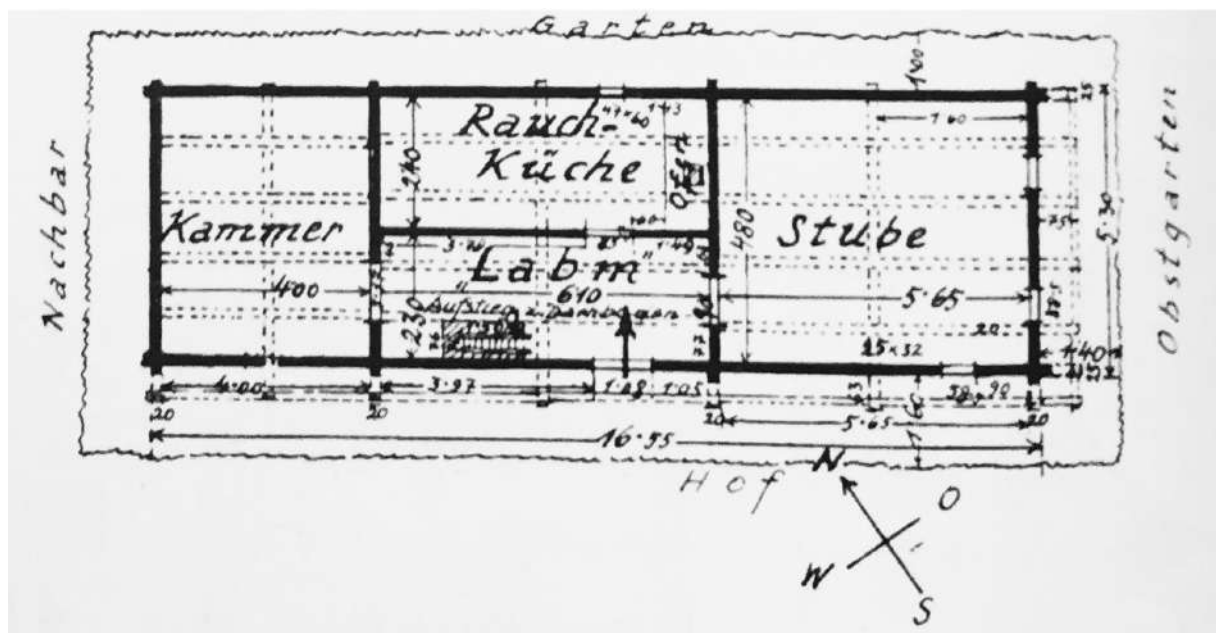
Grundriss eines dreiräumigen Wohnspeicherhauses, 1780
